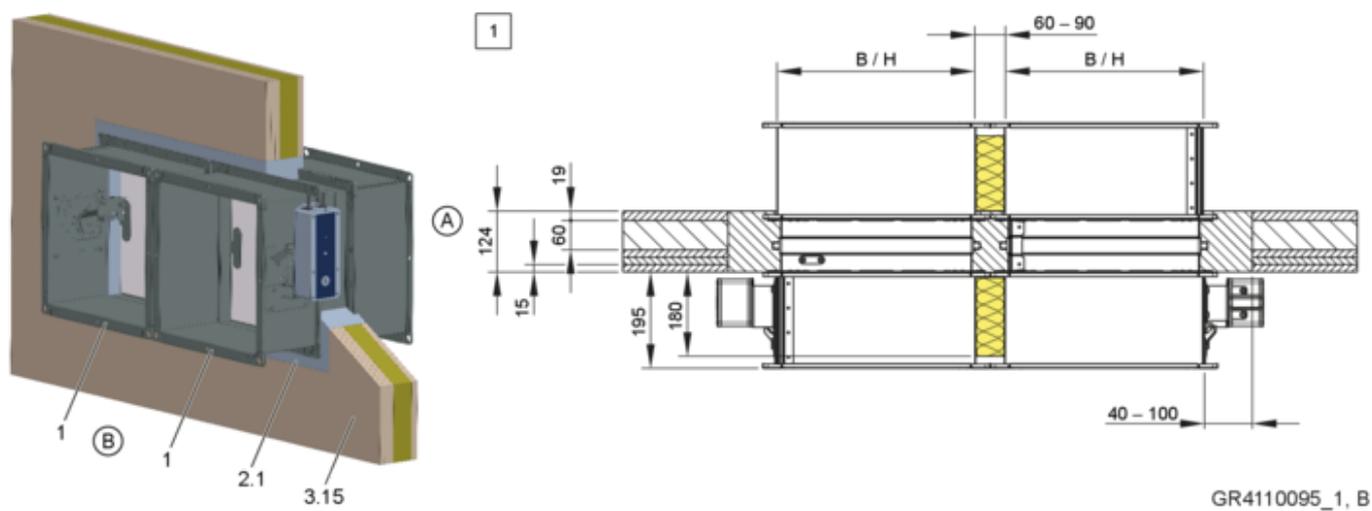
Montagem em argamassa em paredes de caixa assimétricas, "flange a flange", desenhadas uma ao lado da outra (também se aplica à disposição por baixo de cada uma)
